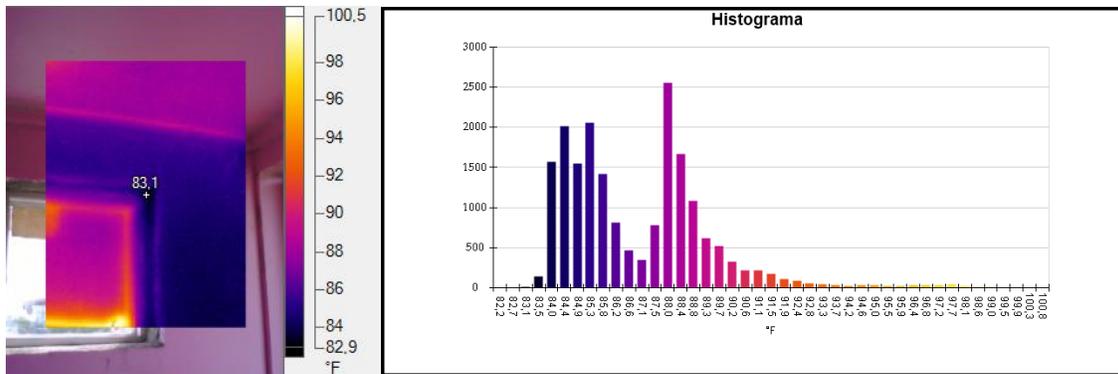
Foto térmica de la esquina ventana 2 en el muro ubicado al sur.
